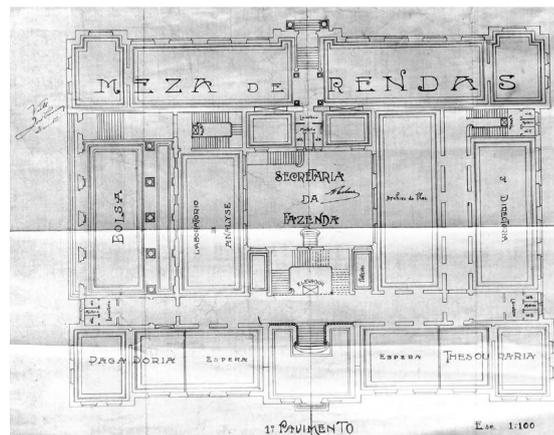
Planta baixa Secretaria da Fazenda, Affonso Hebert.
